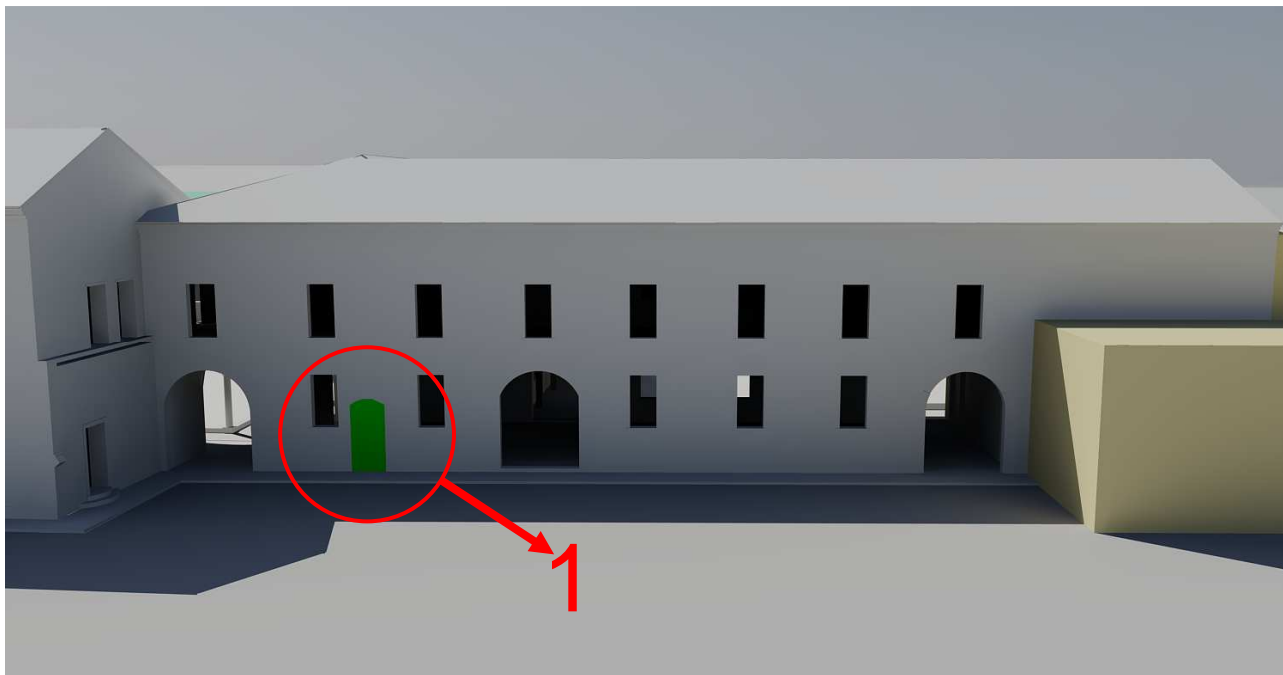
Nel particolare l'individuazione del tamponamento n.1.
